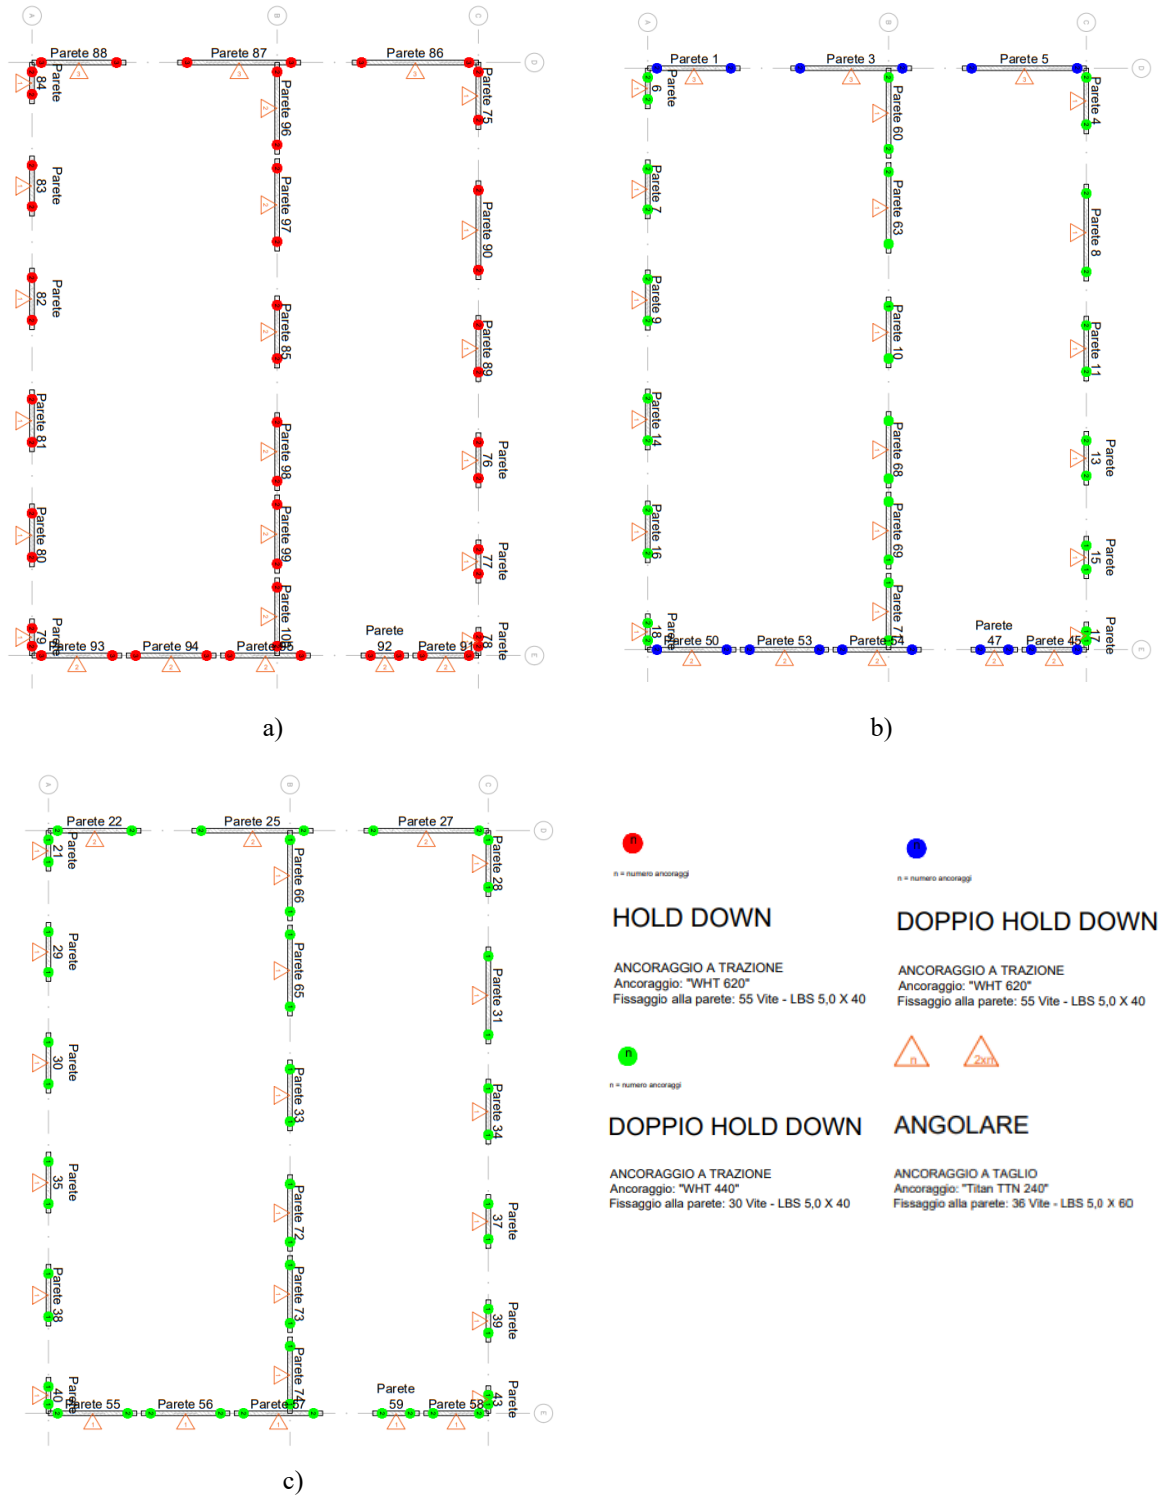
Schema planimetrico della disposizione dei dispositivi di fissaggio: a) pianta del primo livello, b) pianta del secondo livello (scala 1:200).
